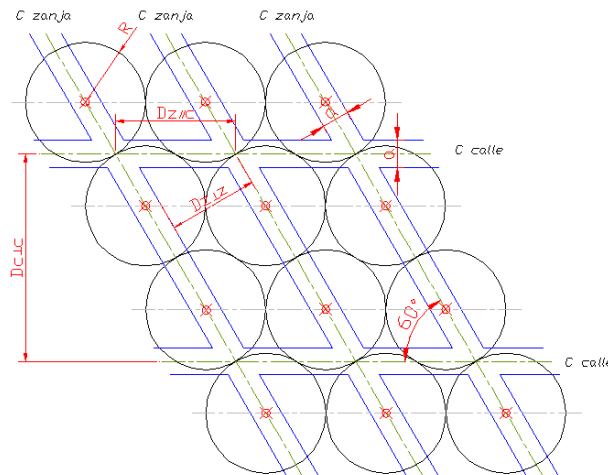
Planta de Malla de Extracción Tipo Teniente. Fuente: Cavieres (2011).
